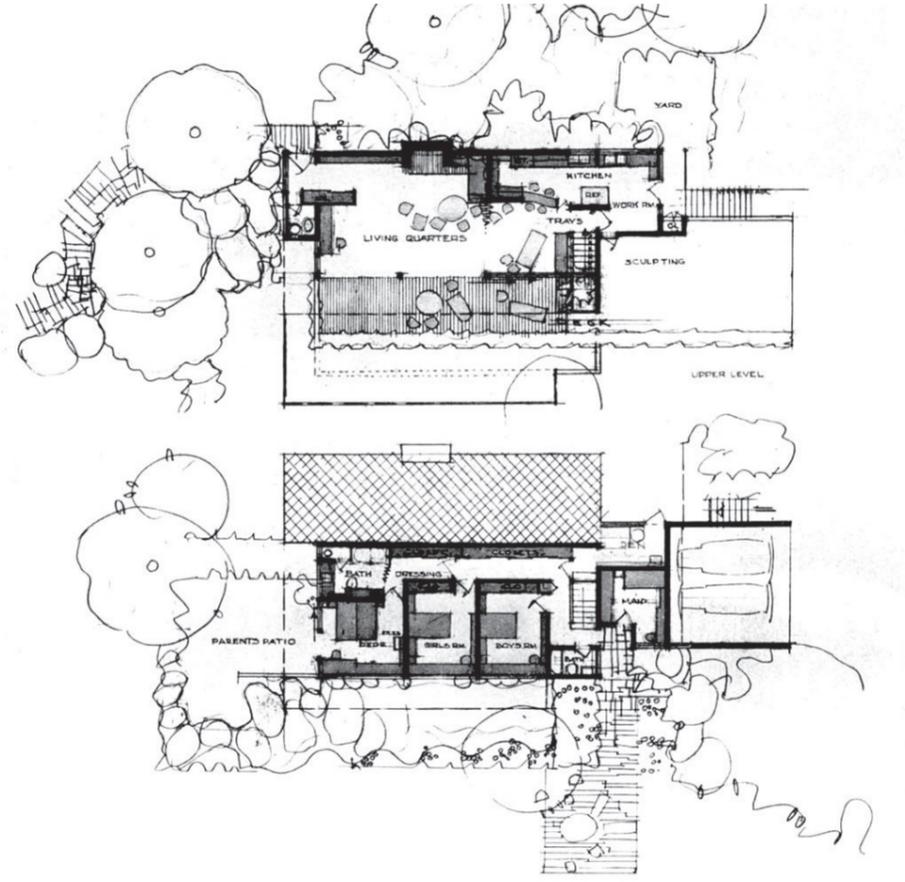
Dibujo de la planta baja y la planta primera de la CSH#21
